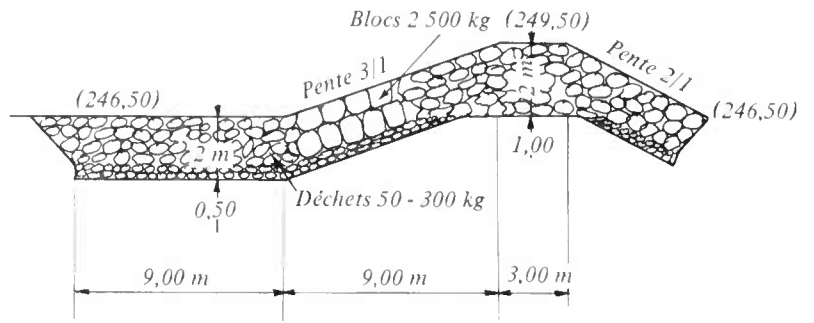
Pont de Nay - Coupe en travers du seuil.
